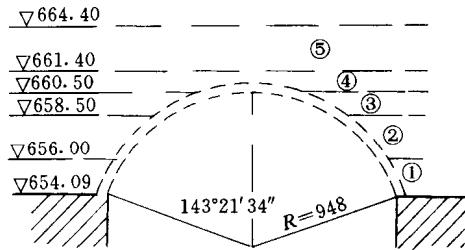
乌江渡坝内副厂房预制薄拱及现浇混凝土分层示意图
